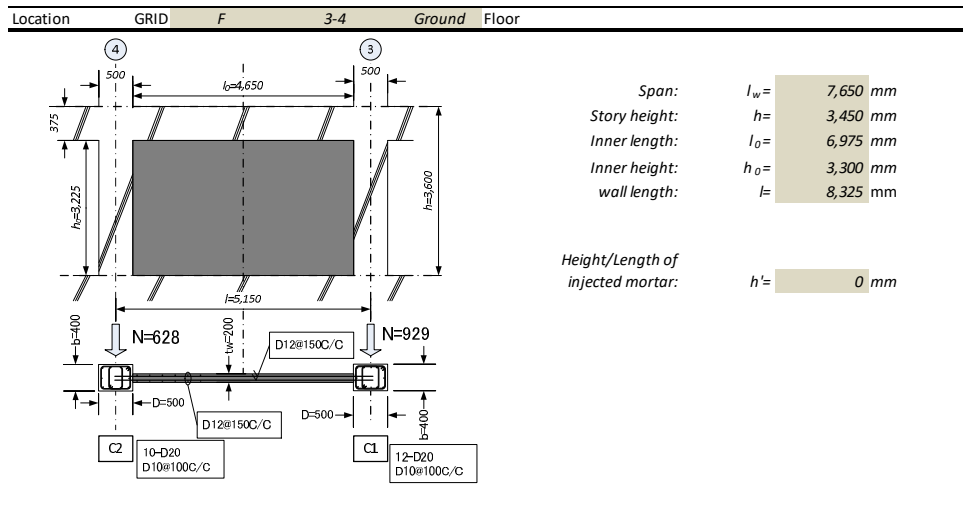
耐震壁 (Shear wall: Detail)の計算例 : 1st 12 Story Building
